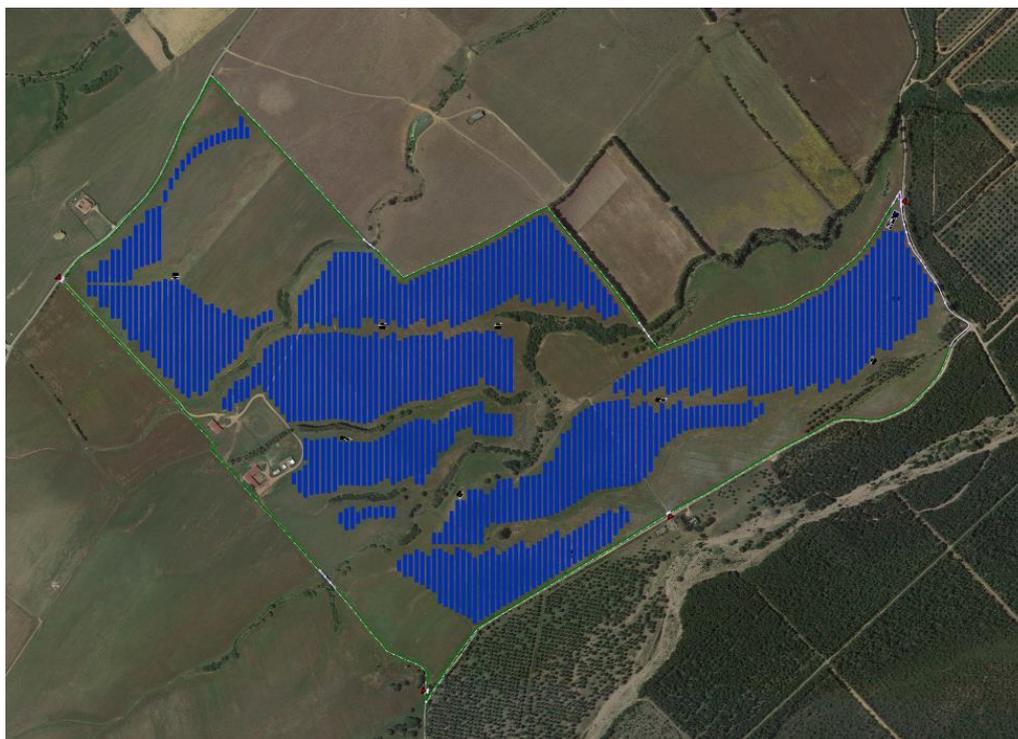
Aree interessate dall'impianto agrivoltaico in progetto.
